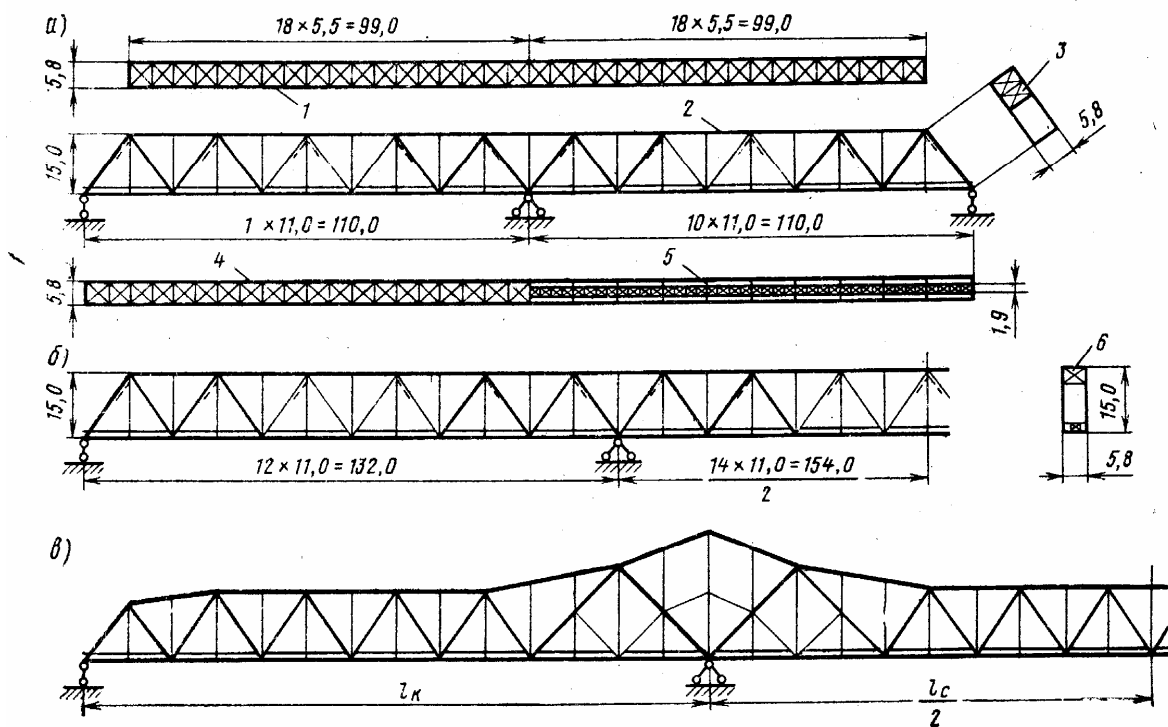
Схемы пролетных строений с неразрезными фермами
